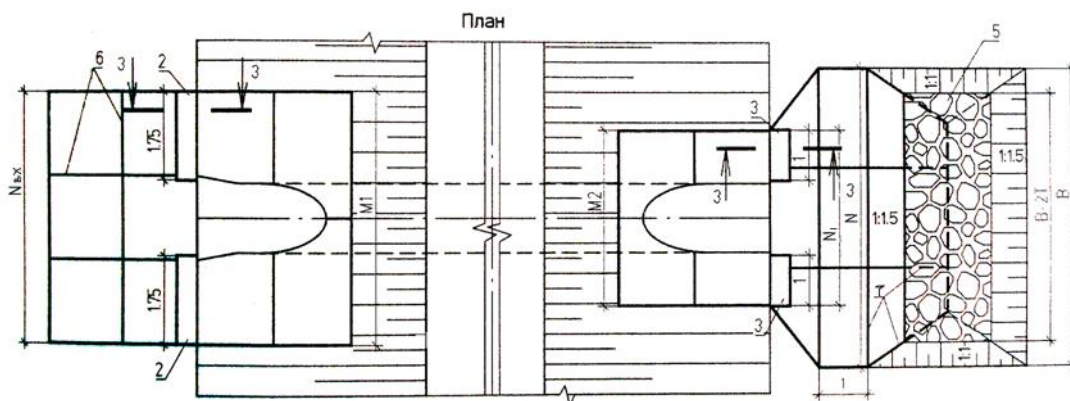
Схемы плана трубы при укреплении: а) плитами ПК100.12.е; б) русла на выходе монолитным бетоном, русла на входе и откосов плитами ПК50.8.е; в) монолитным бетоном: 1- плиты; 2, 3 – блок упора; 4 – бетон В25; 5 – наброска камня; 6 – строительный раствор; 7 – антисептированные доски
